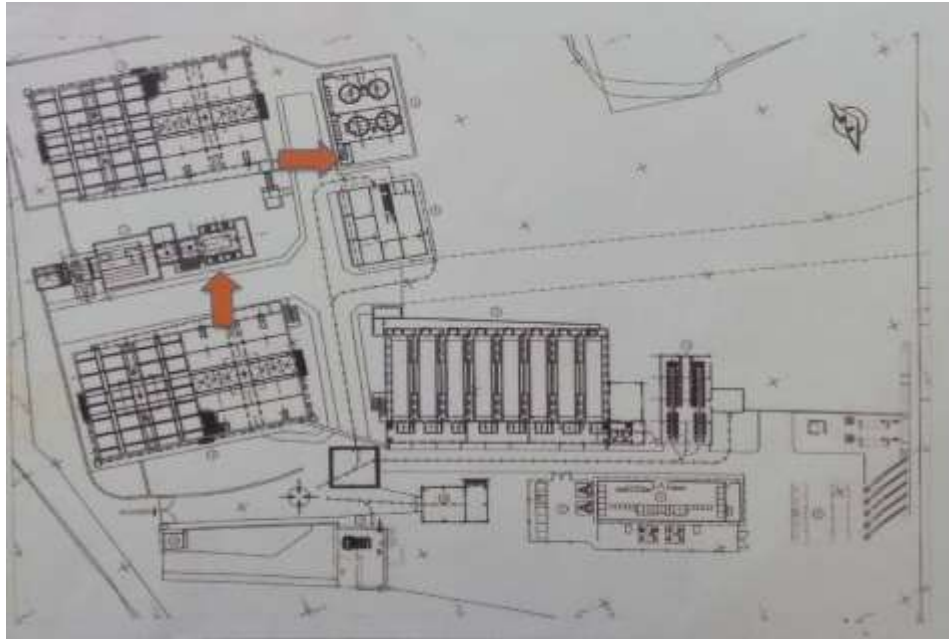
Plano de ubicación de la planta potabilizadora, ruta de acceso del camión y lugar de descarga.
